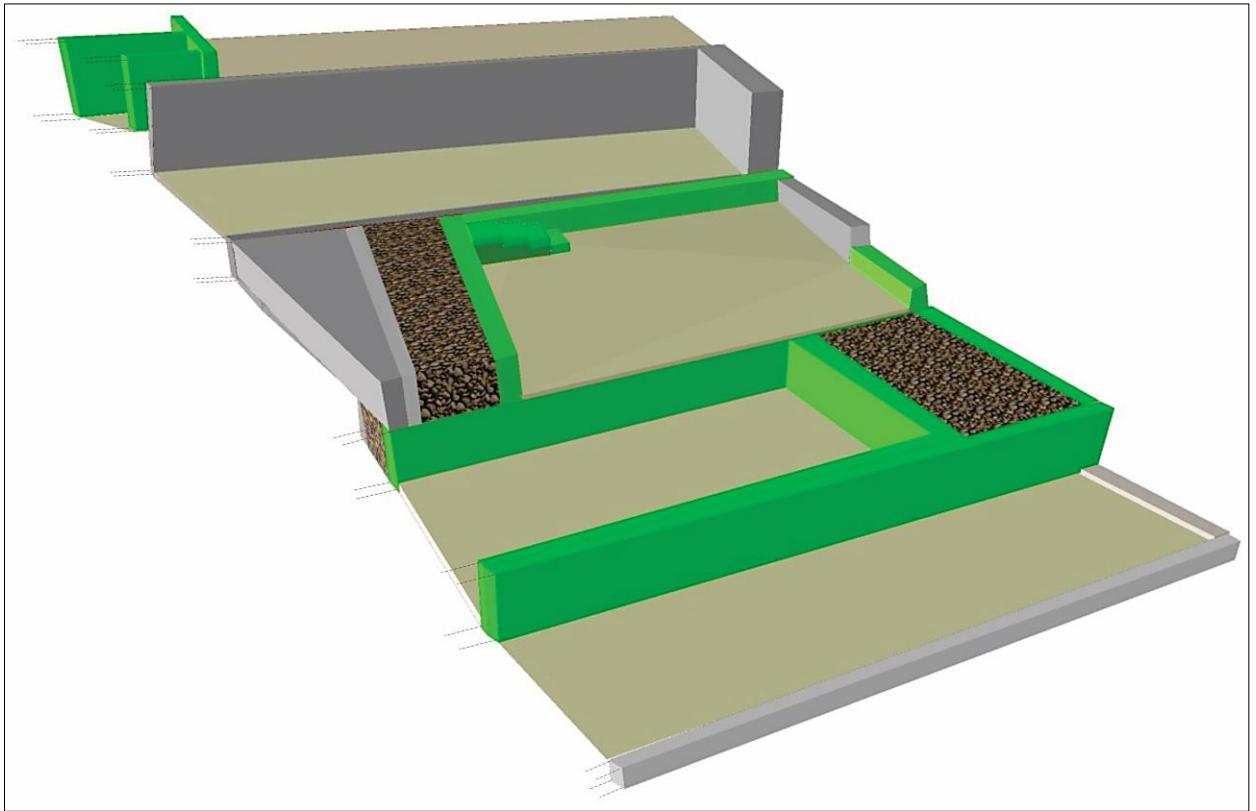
Reconstrucción isométrica (S-N) del Segundo Momento Constructivo (II). Notesé las nuevas construcciones (verde) y remodelaciones sobre la base de los momentos constructivos anteriores. Fuente: Elaboración propia.
